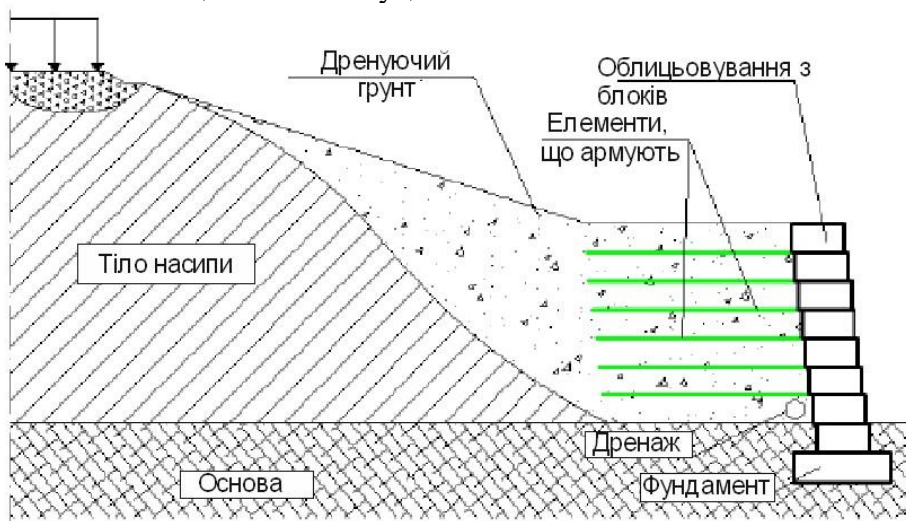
Схема поперечного профілю насипу, посиленого армогрунтовою стіною з облицюванням з блоків
